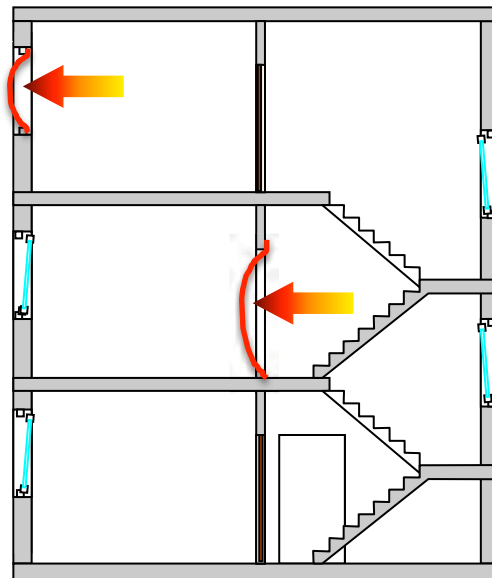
Die Druckverhältnisse am Fenster und auch zB. von Türen werden durch eine Abklebung mit einer Folie am besten bei offenem Fenster einfach sichtbar.
